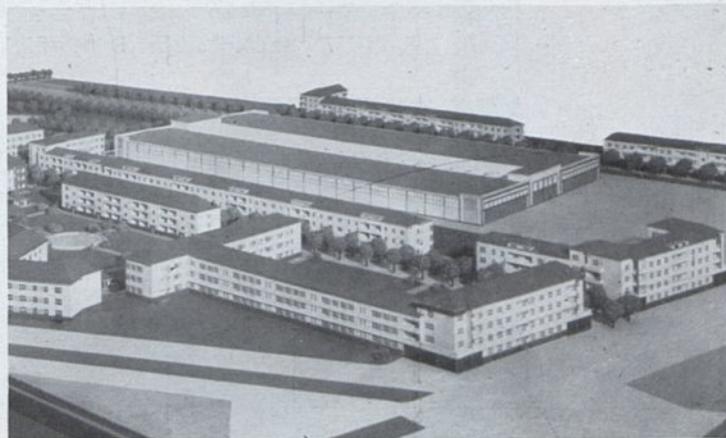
Straßenbahnhof Britz. Modellaufnahme.
